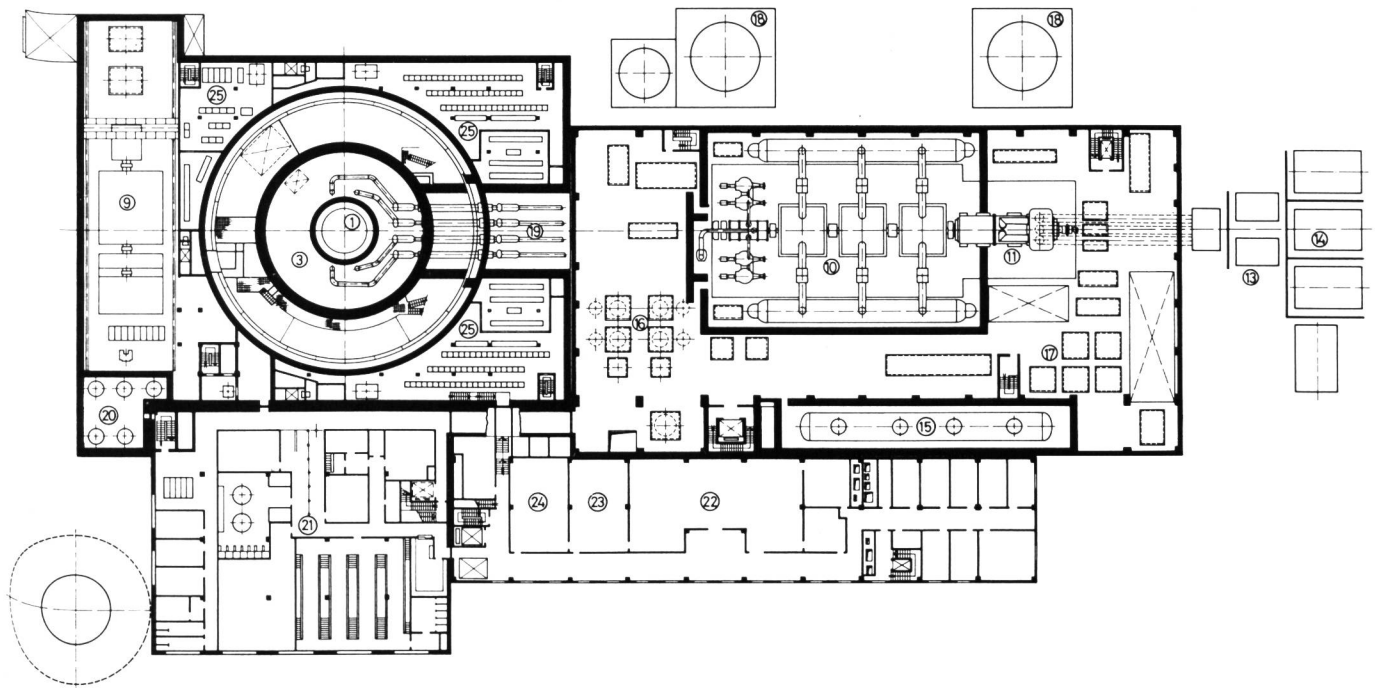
Grundriss von Reaktorgebäude und Maschinenhaus
